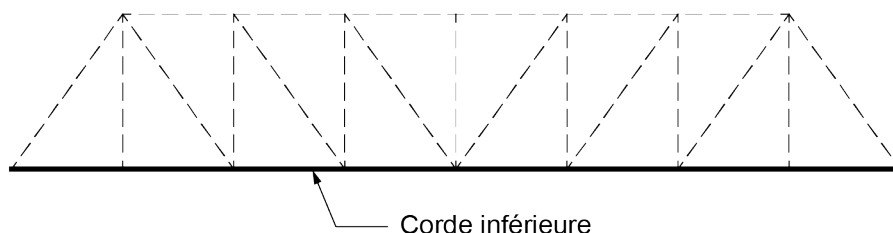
Corde inférieure d'une poutre triangulée
